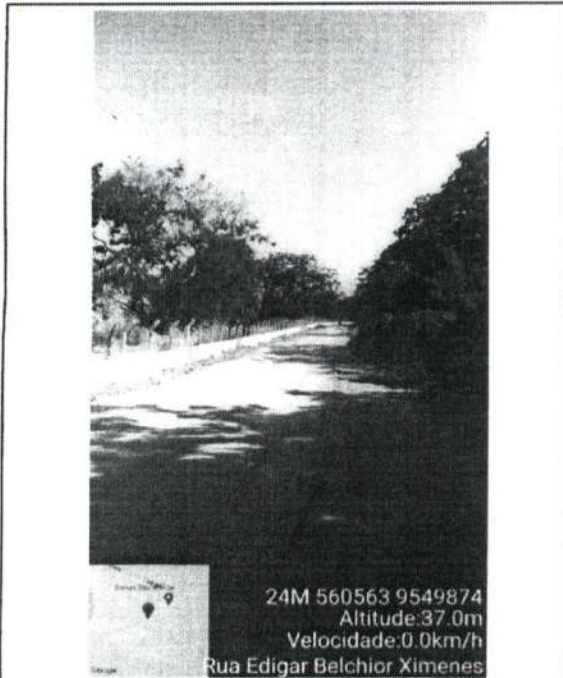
FOTO Nº	RUA EDIGAR BELCHIOR - BAIRRO CACHOEIRA
